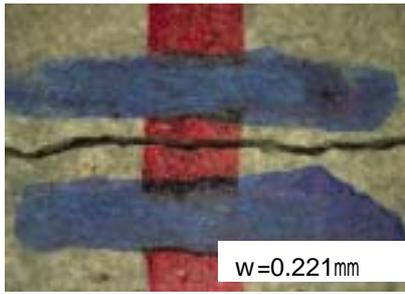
配合 4 養生条件 H ひび割れ導入後
